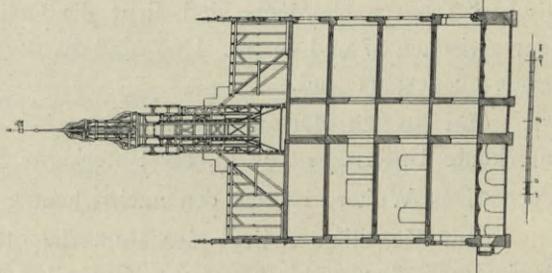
Hauptgebäude. Querschnitt durch das Vordergebäude. Mittelbau.
